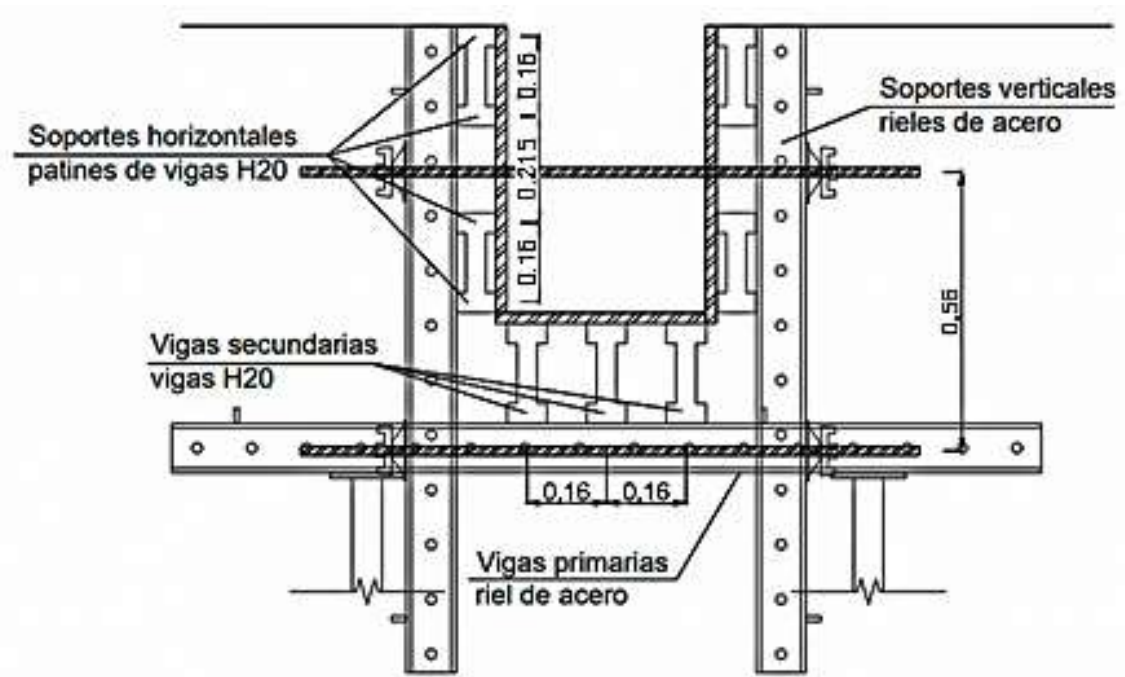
Distribución de elementos para un encofrado de vigas de concreto mediante vigas H20. Reyes, [Ilustraciones de encofrados, varias], (2020).
